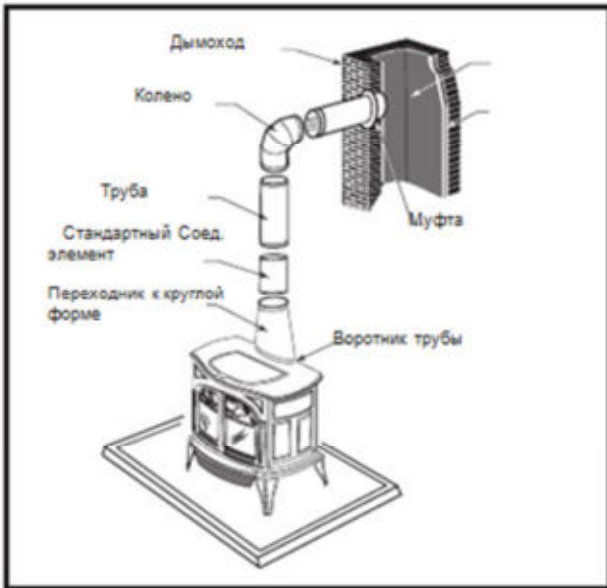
Изображение соединительного элемента дымохода при свободстоящей версии установки
